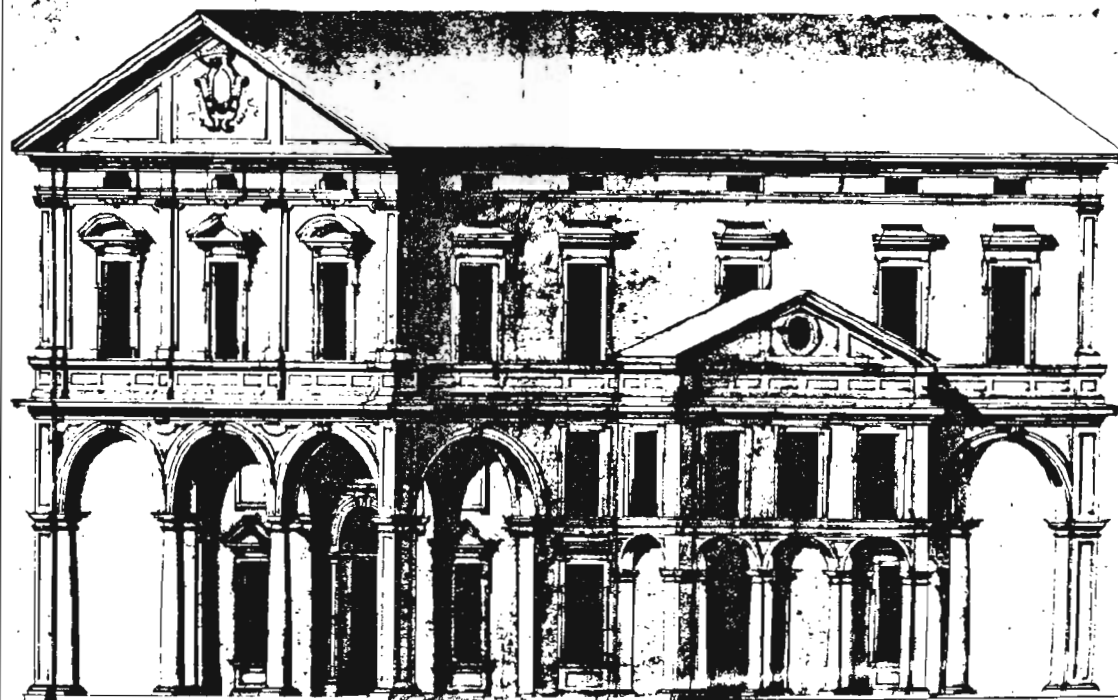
Artista alemán. Diseño de ayuntamiento. Alzado. Tinta sobre pergamino, 102 x 38.6. Akademie der Bildenden Künste, Viena.
